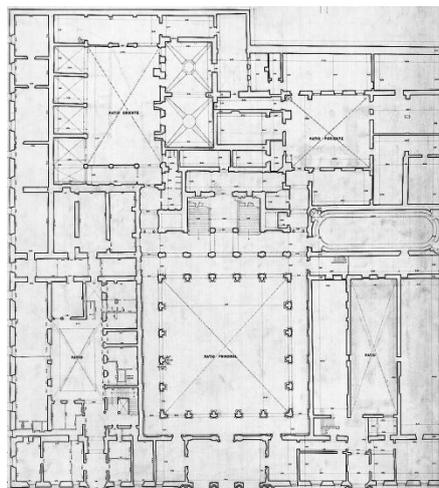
Plano limpio tratado con un editor de imagen , planta baja Palacio de minería
